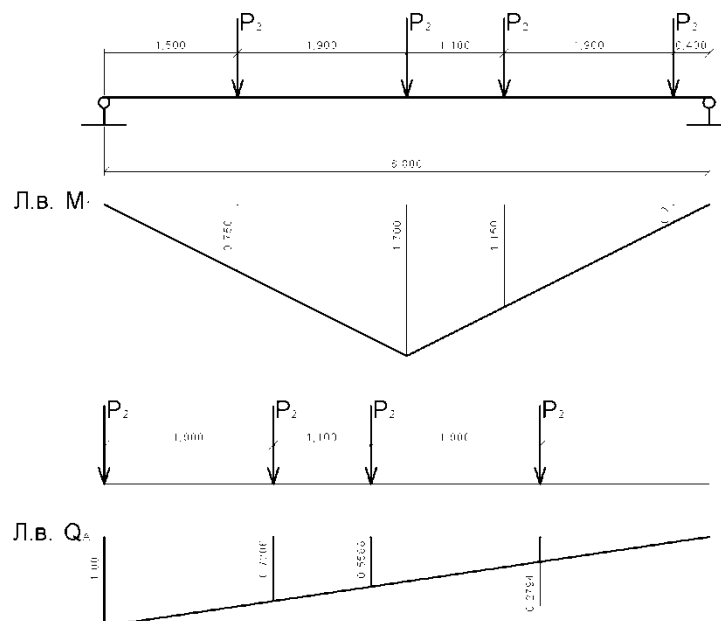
Завантаження ділянки поперечної балки між головними балками прогонової будови.
